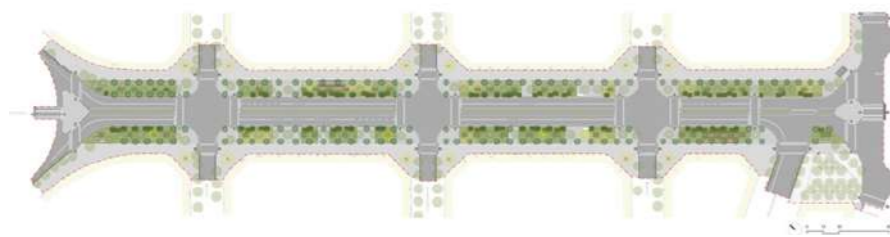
Planta arquitectónica de conjunto general. FUENTE: Adriá Goula, sin fecha.
